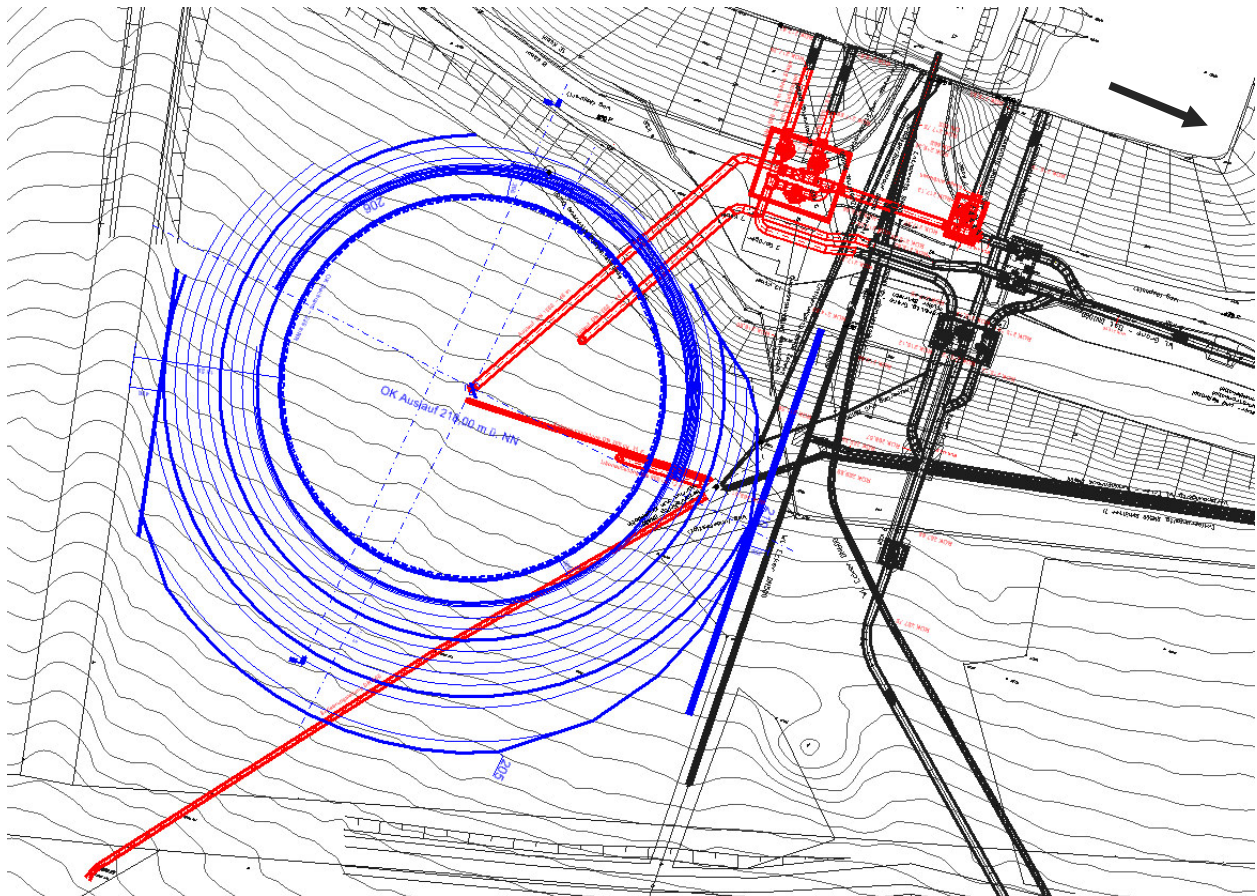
Variante C-2 Lageskizze mit Rohrleitungen und Schachtbauwerken
